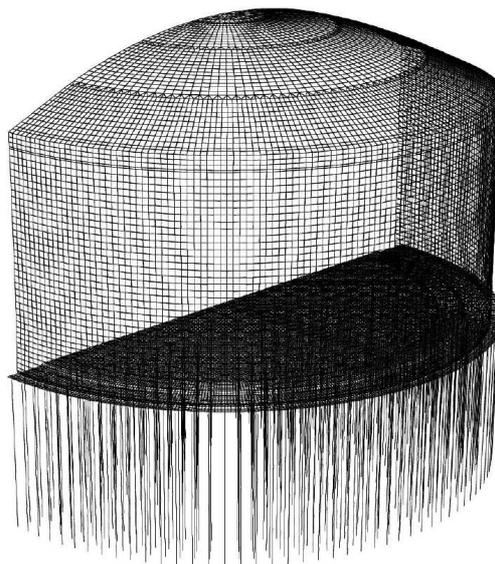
vue d'ensemble du modèle 3D HERCULE
